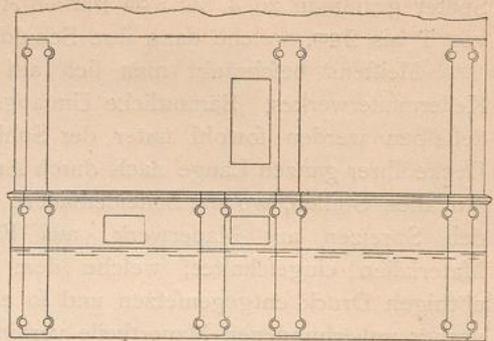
Grundriss des Kellergeschosses.
